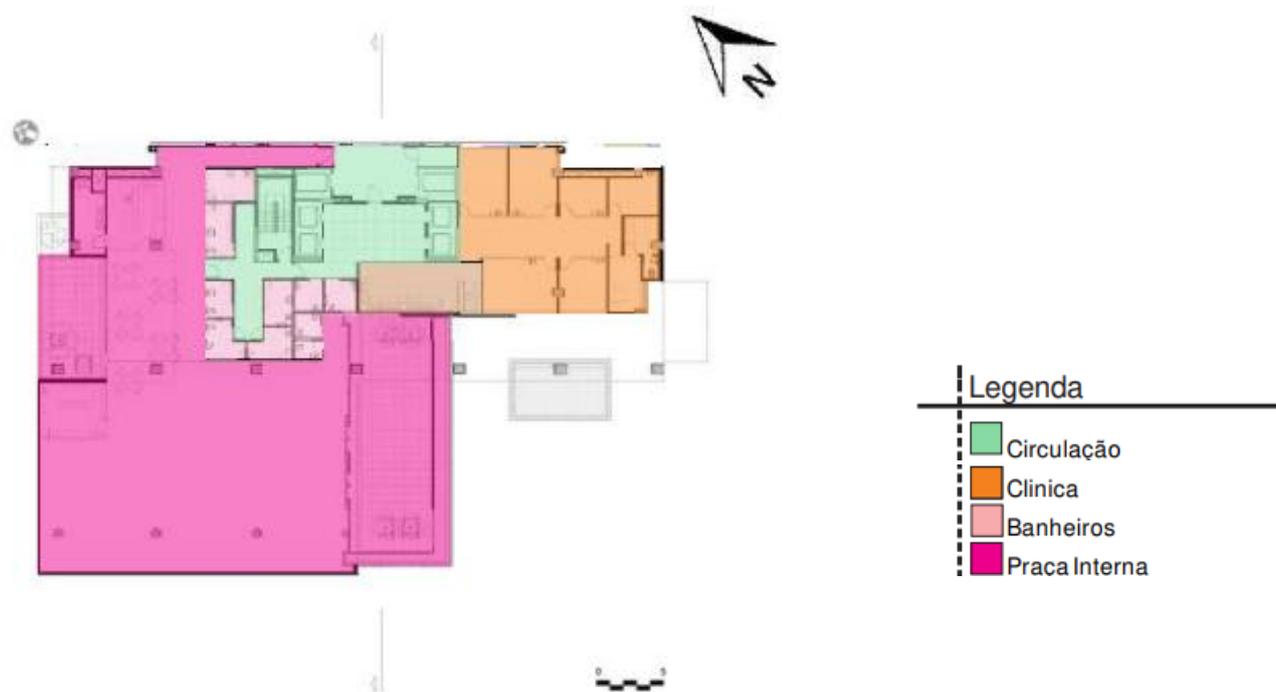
Restaurante – Pavimento Térreo Edifício Hiléa.
